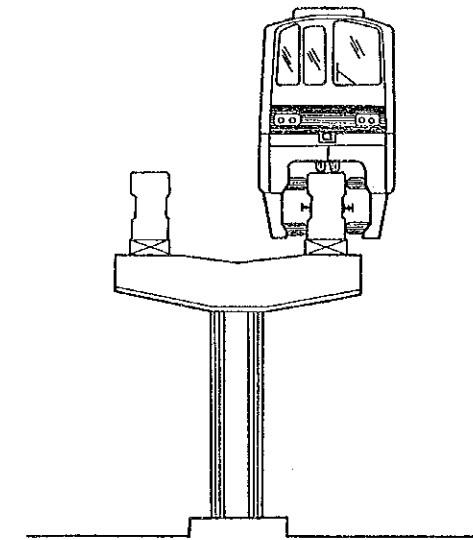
Structure du monorail à cheval sur poutre
